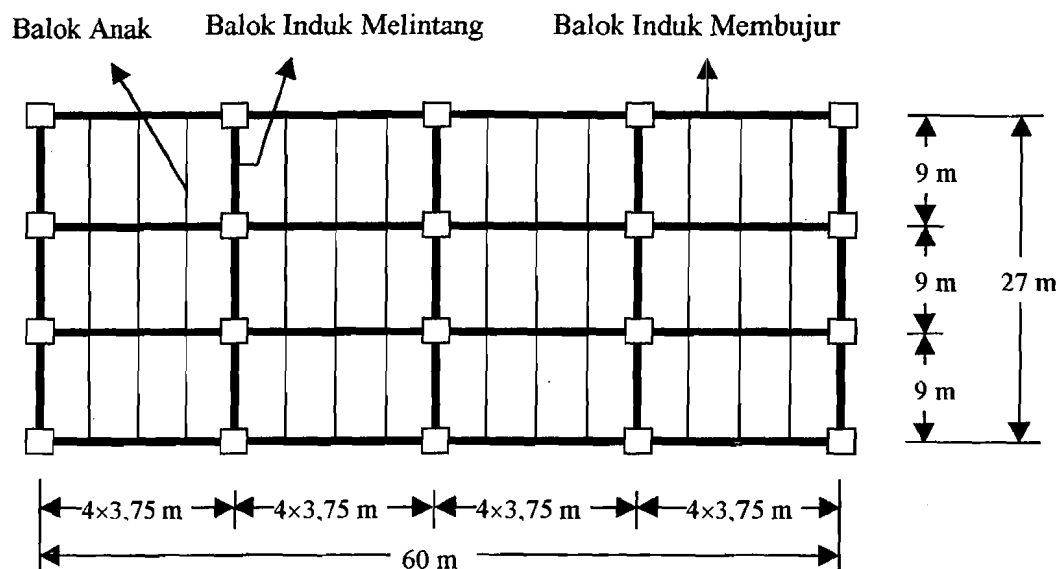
Denah Penempatan Balok Anak Tipe A
